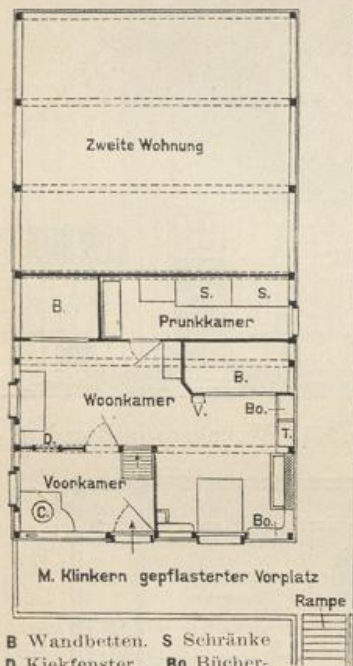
Wohnhaus in Zaandam. Grundriß zu Abb. 327.
